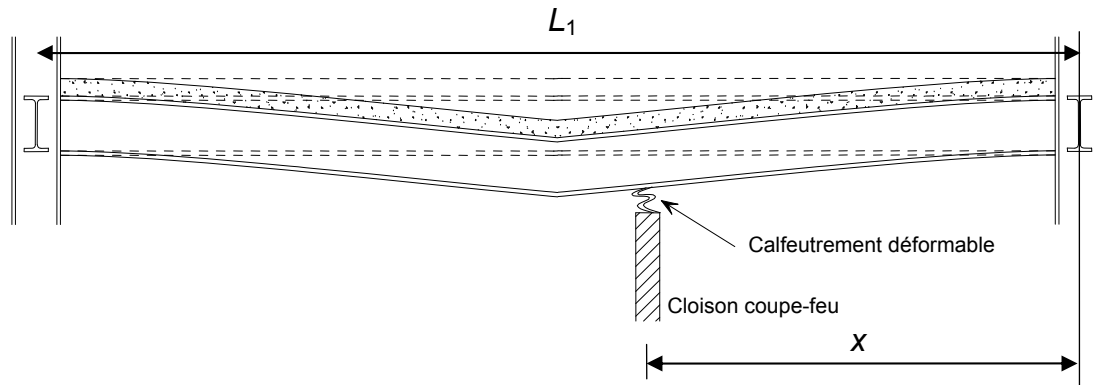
Déformation de poutres disposées transversalement aux murs
